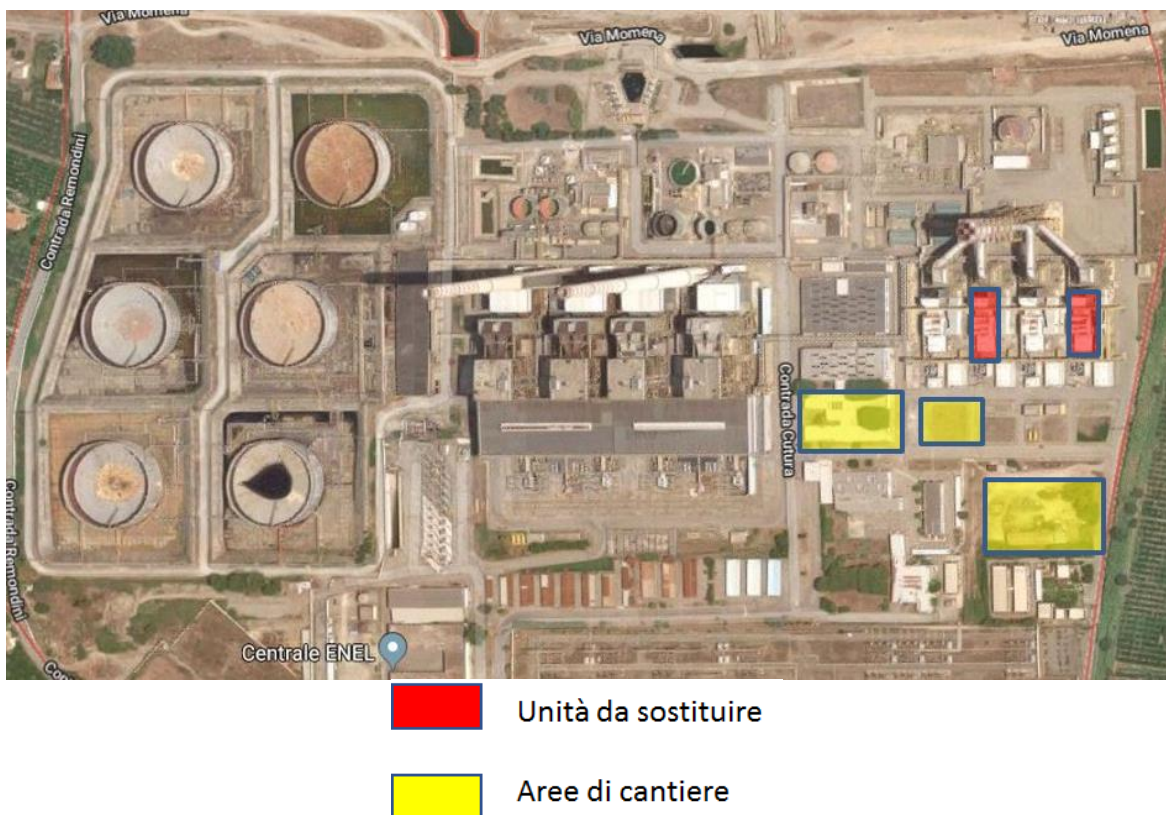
Individuazione delle aree di cantiere e delle unità da sostituire
